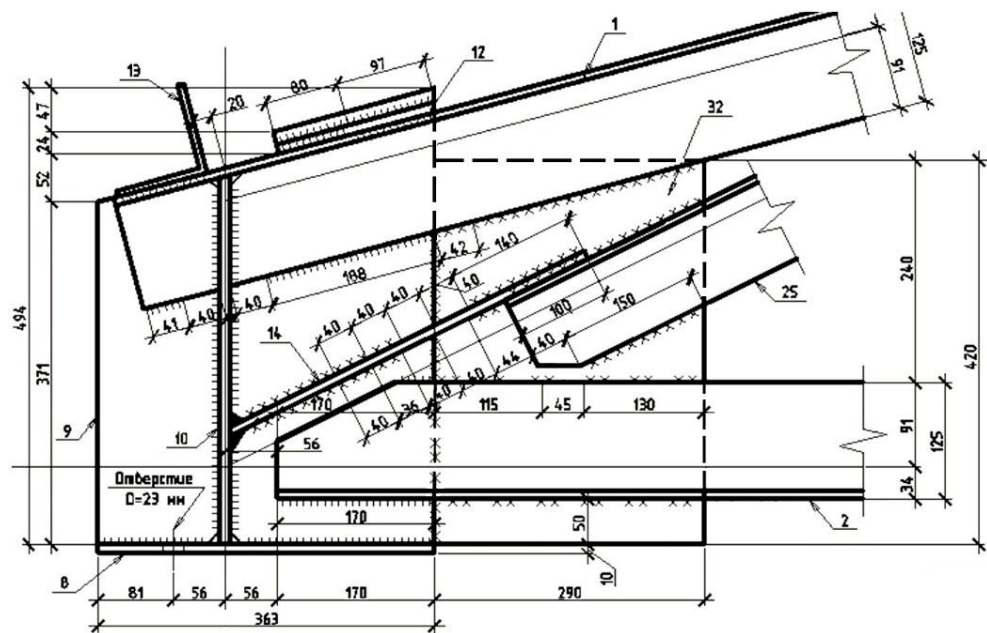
Конструкция опорного узла фермы, выполненная согласно рекомендациям по проектированию в «Руководстве по проектированию сварных ферм из одиночных уголков»
